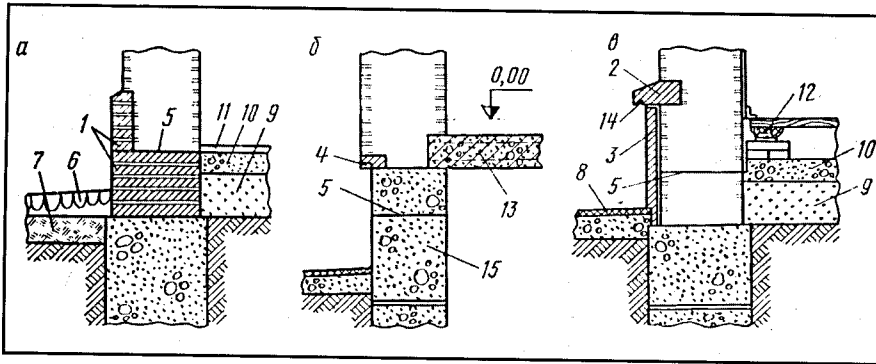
Цоколі цегляних стін: а - облицьовані цеглою; б - цоколь без виступу в будівлі з підвалом; в - облицьований кам'яними плитами; 1 - клінкер; 2 - кордонний камінь; 3 - кам'яні плити; 4 - залізобетонні бруски 75 x 120 мм; 5 - гідроізоляційний шар.
